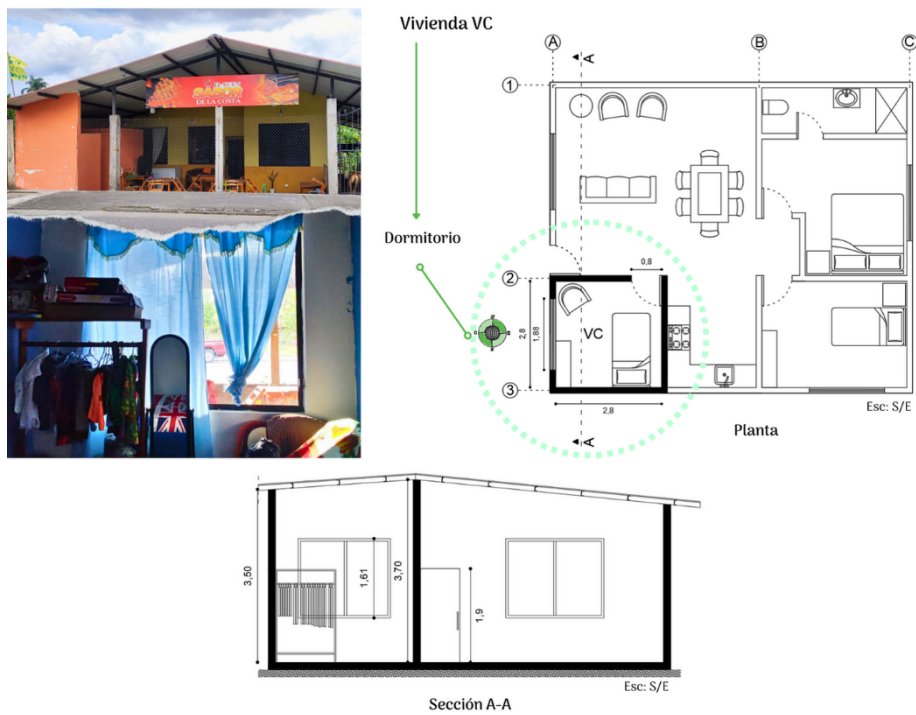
Planta y sección arquitectónica de la vivienda VC.
